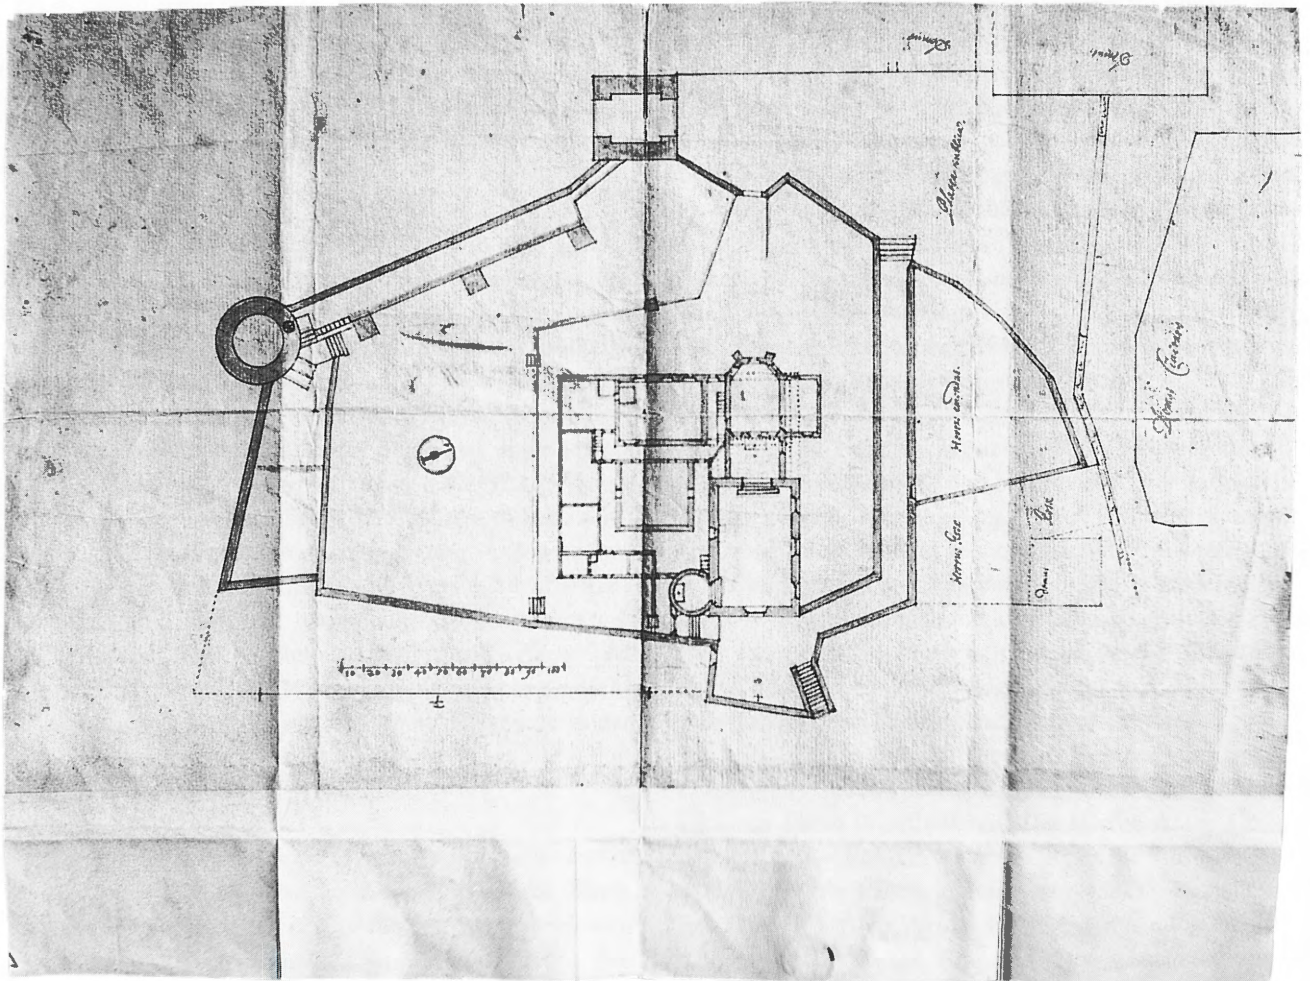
Grundriss des ersten Kapuzinerklosters in Zug, 1674.
